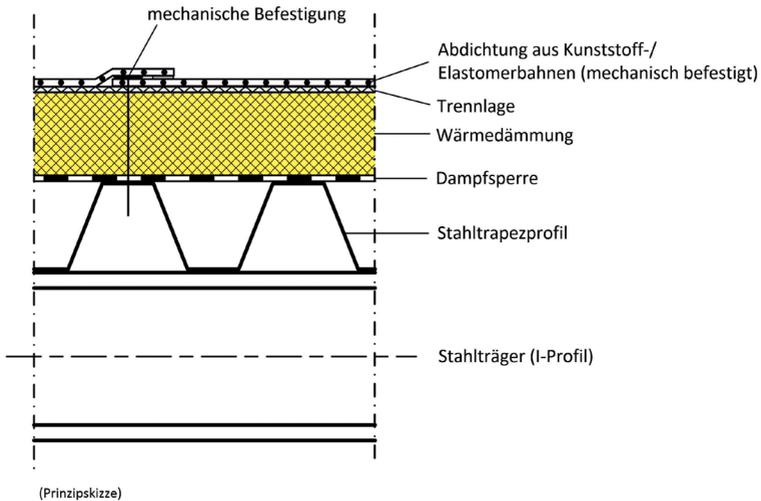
Nicht belüftetes Dach als Konstruktion auf Stahltrapezprofilen (Quelle: Schmidt)
